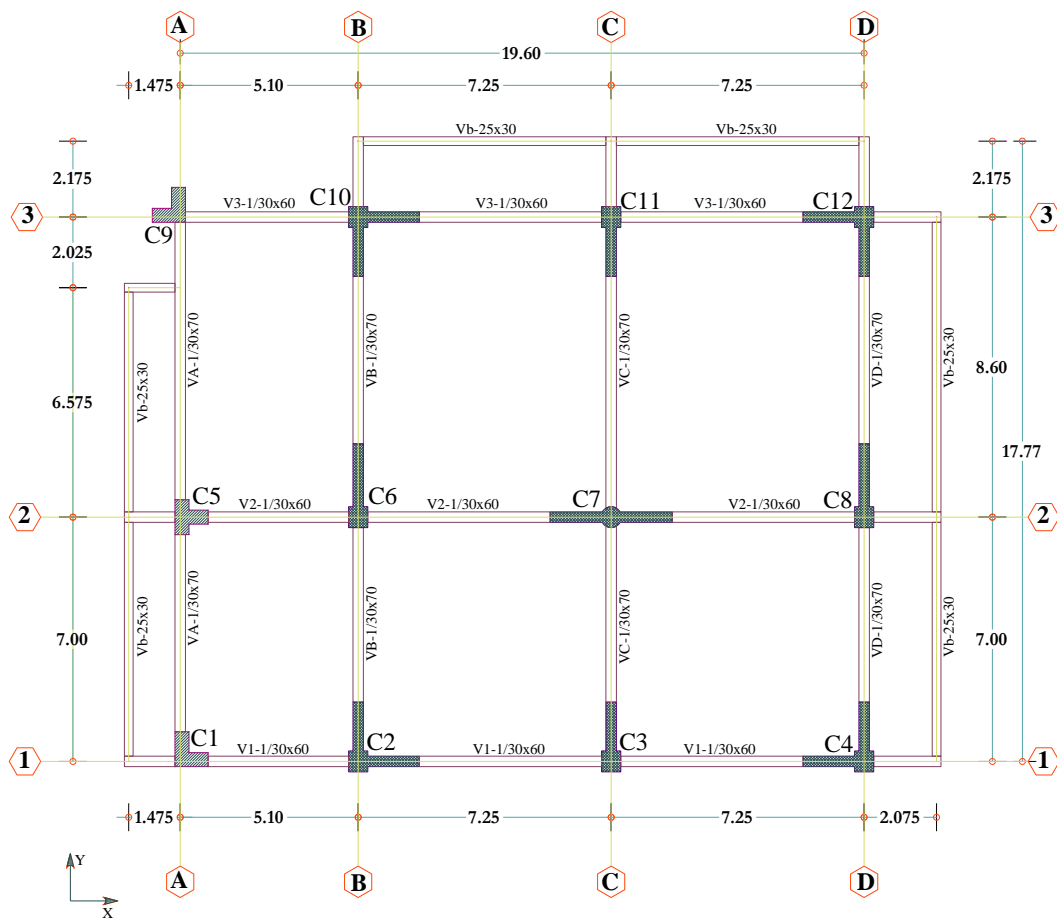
Voladizos más sobresalientes, planta primer y segundo nivel
